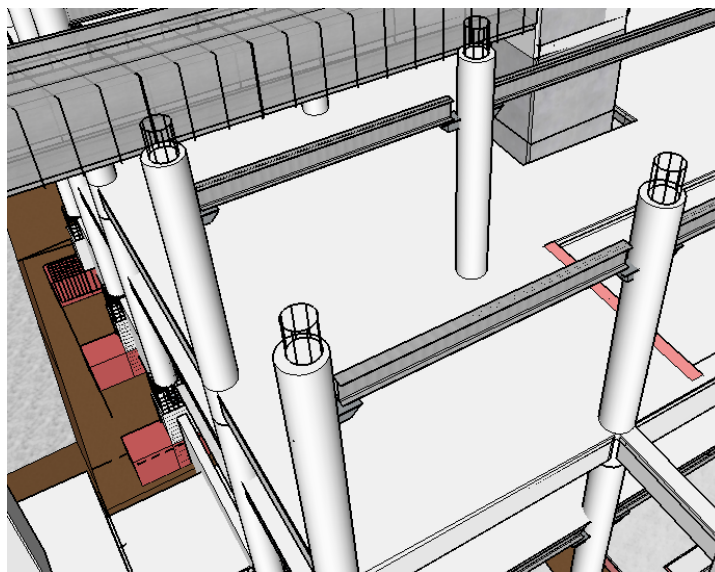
Render de colocación de vigas metálicas principales en losa
